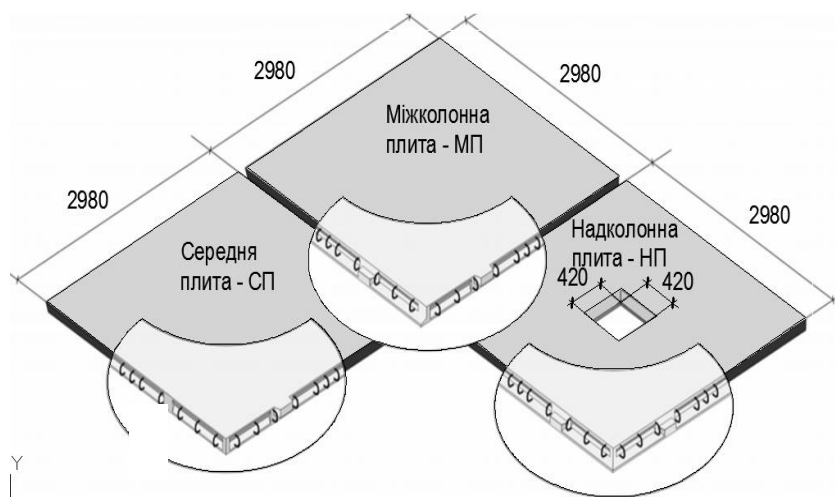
Схема розташування плит перекриття та влаштування стиків між ними
